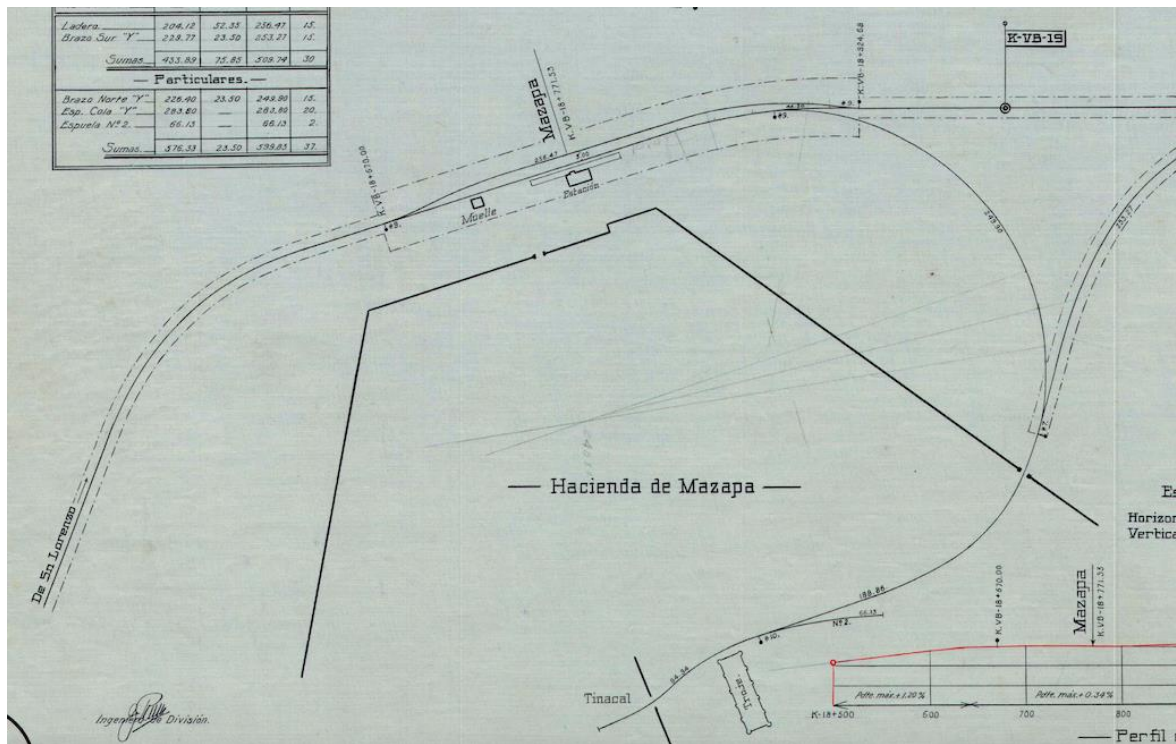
Plan technique de la gare et de l’hacienda de Mazapa. Même si en principe ce plan n’illustre pas trop de détails techniques à propos de la gare, il montre comment ce type d’haciendas connectaient ses tinacales –les endroits où elles stockaient le pulque- avec les gares. Dans le plan, le tinacal se trouve où milieu en bas et la gare au milieu en haut.
